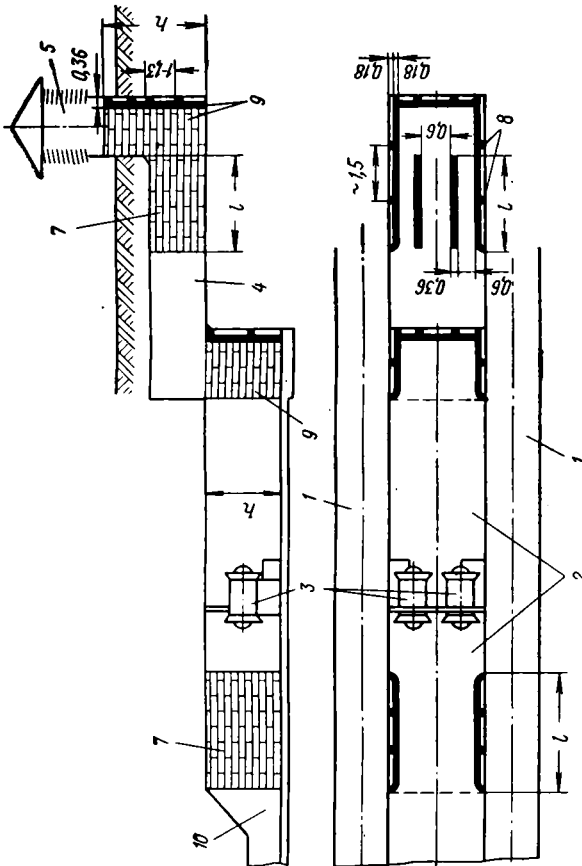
Схема размещения с двумя поворотами пластинчатых глушителей шума из бетонных шумопоглощающих блоков в вентиляционной установке тоннельной вентиляции, расположенной на станции метростроения мелкого заложения, с выпуском воздуха на станцию через подплатформенный канал:
